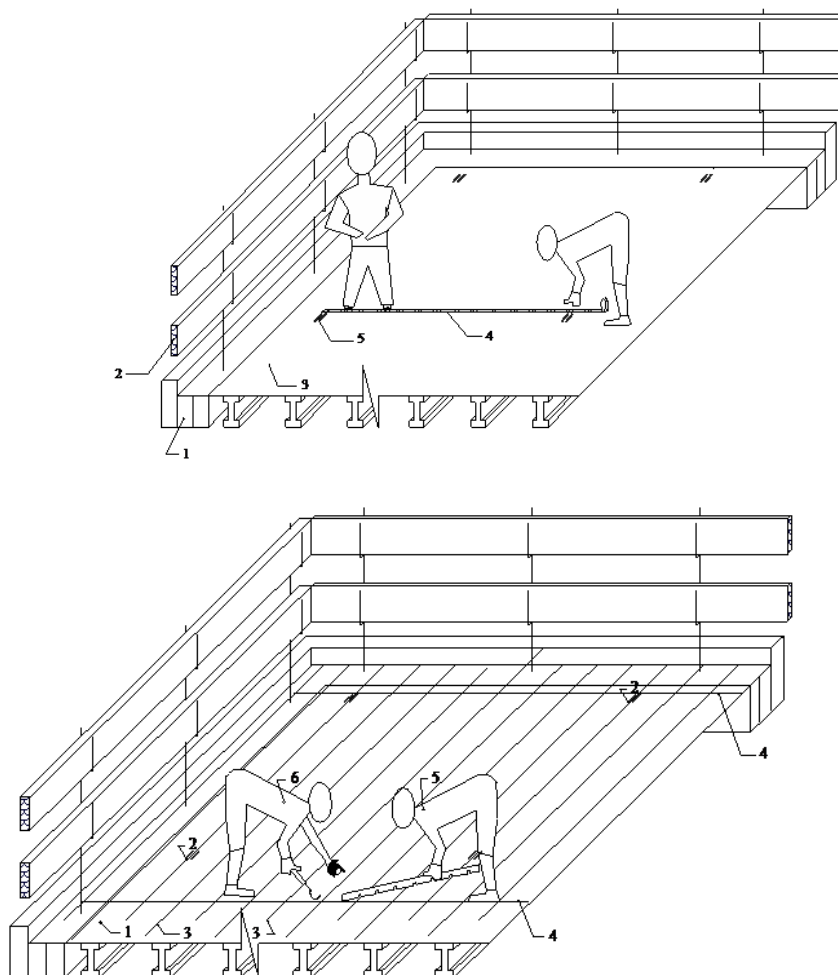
Разбивка палубы при устройстве нижней арматурной сетки:
